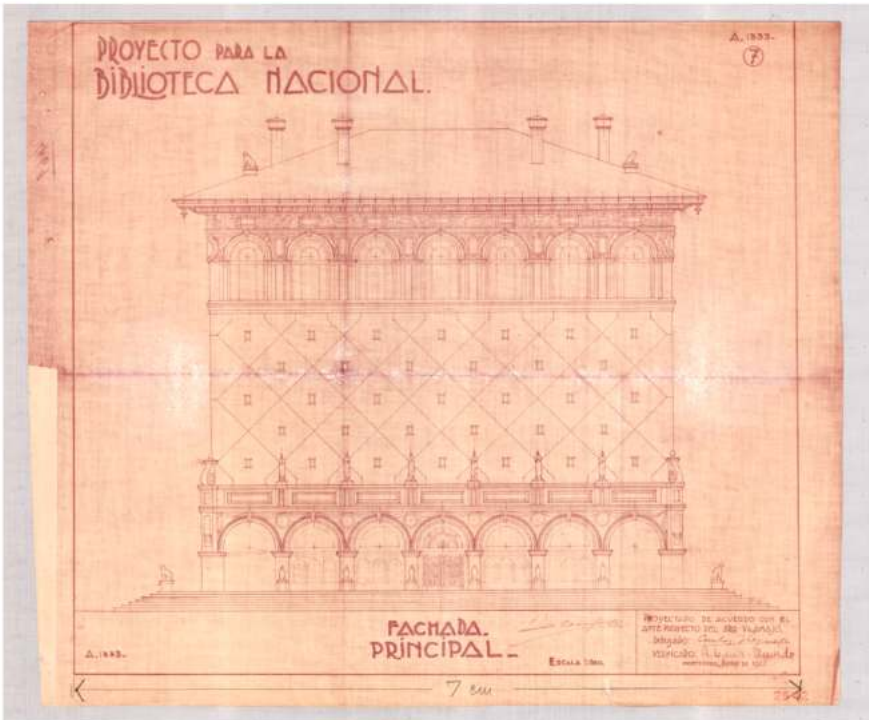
Fachada principal (sobre 18 de Julio) del proyecto para la BN realizado en base al anteproyecto de Vilamajó de 1926. Archivo IHA, plano 2542. Copia del original, en el archivo del MTOP.
